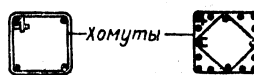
Поперечное сечение стоек, армированных вязаными каркасами.
